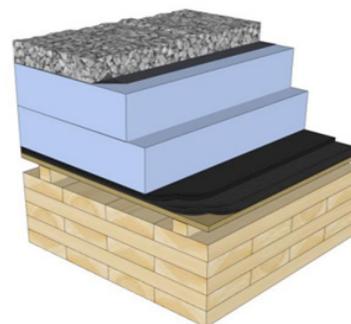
Schéma d'un assemblage de toit incluant un espace de ventilation entre le panneau de revêtement et l'assemblage de bois massif [13]
